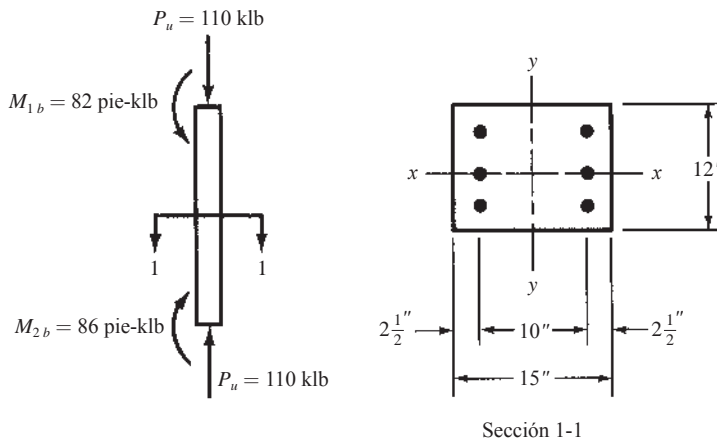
Perfil y sección transversal de la columna del Ejemplo 11.3.
